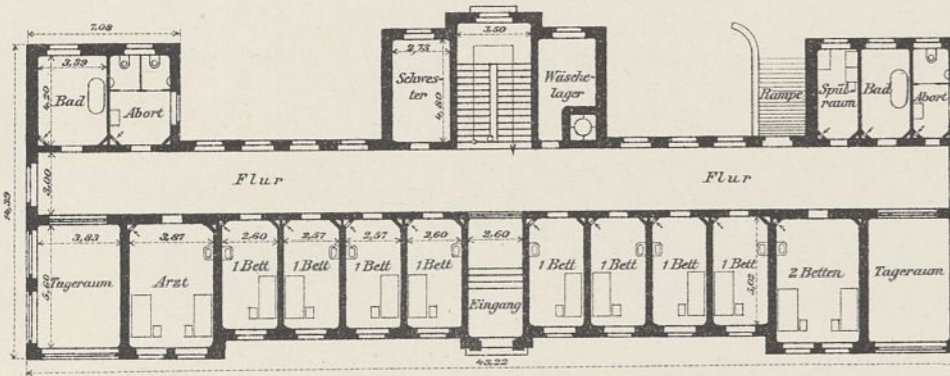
Kostgängerpavillon. Erdgeschoss.
